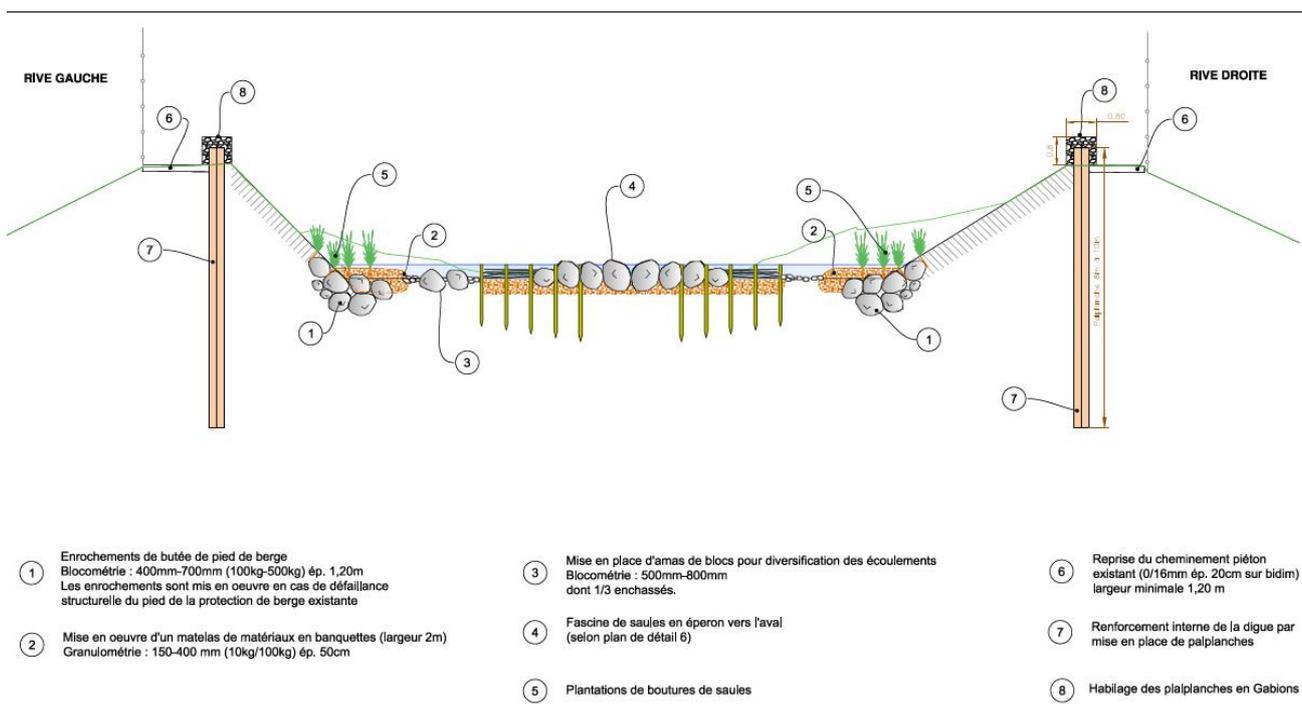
Coupe type 3: palplanches dépassant de la digue (Source : PRO Safège, avril 2018)
